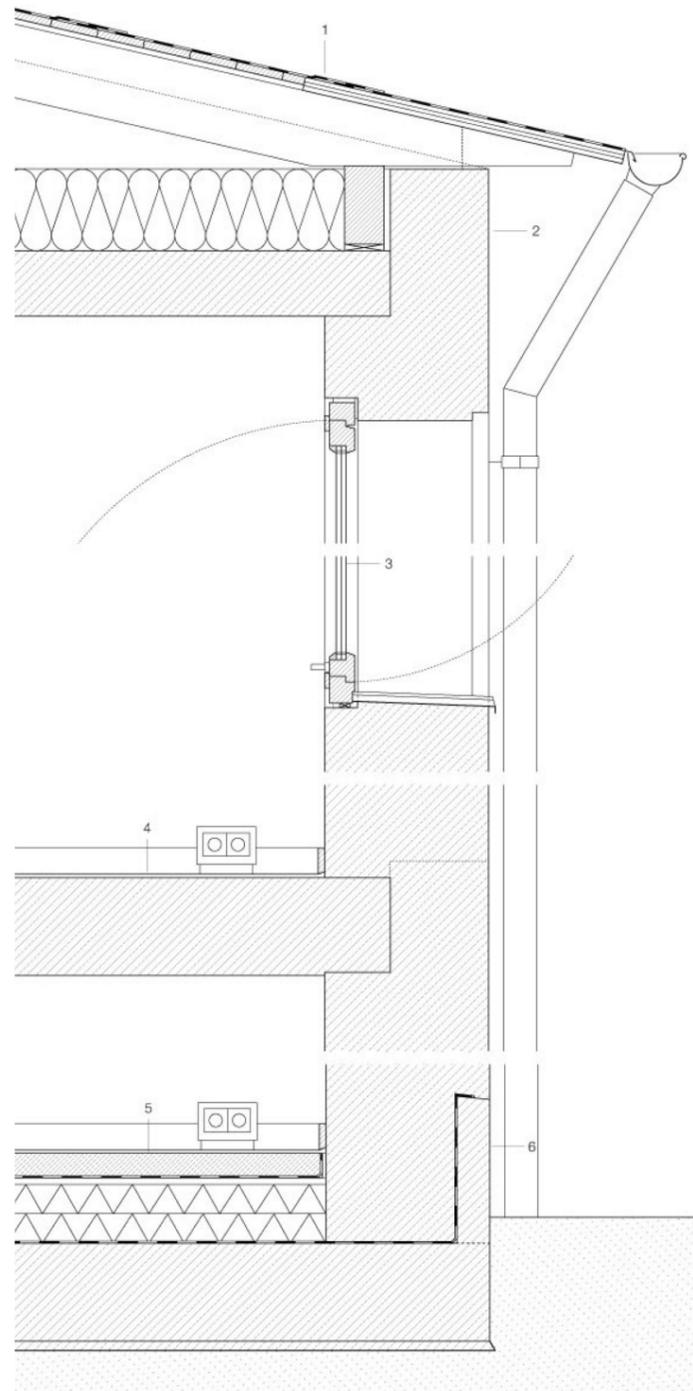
Fassadenschnitt Gebäude Leichtbeton:
